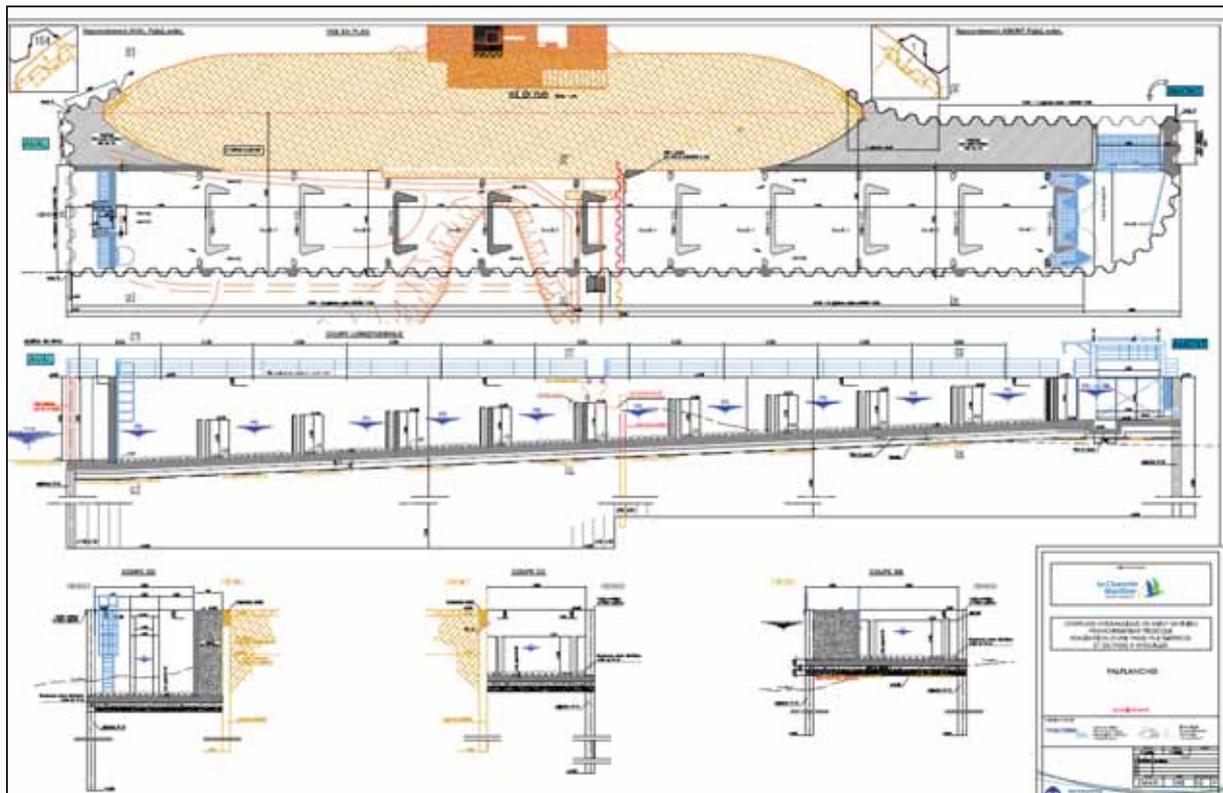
Plan d'exécution de la passe multi-espèces (Plan EXE, CD17 Verchéeenne).
